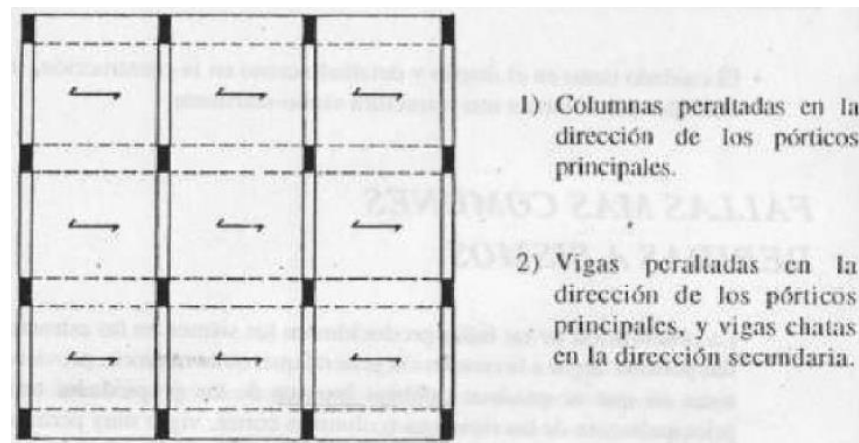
Planta de edificio estructurado con criterio clásico, ineficaz para un país sísmico.
